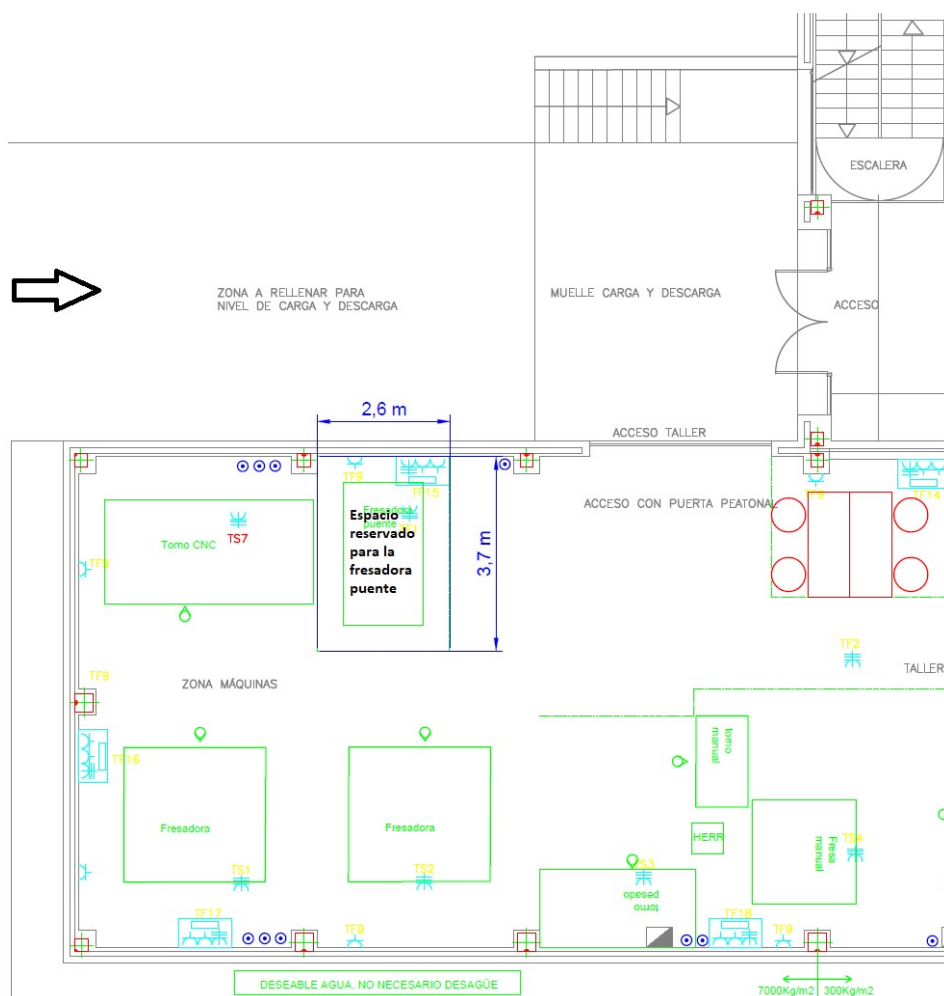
Plano esquemático del taller mecánico donde está prevista la instalación de la fresadora puente.
